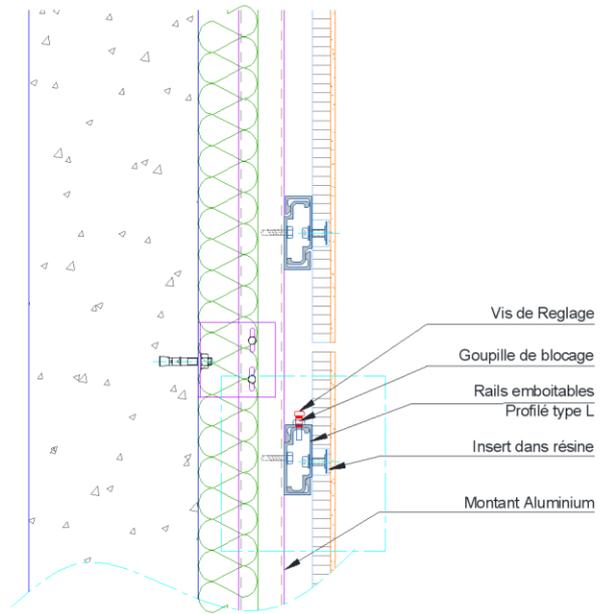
is – Pose en sous-face ou inclinée (coupe horizontale)
